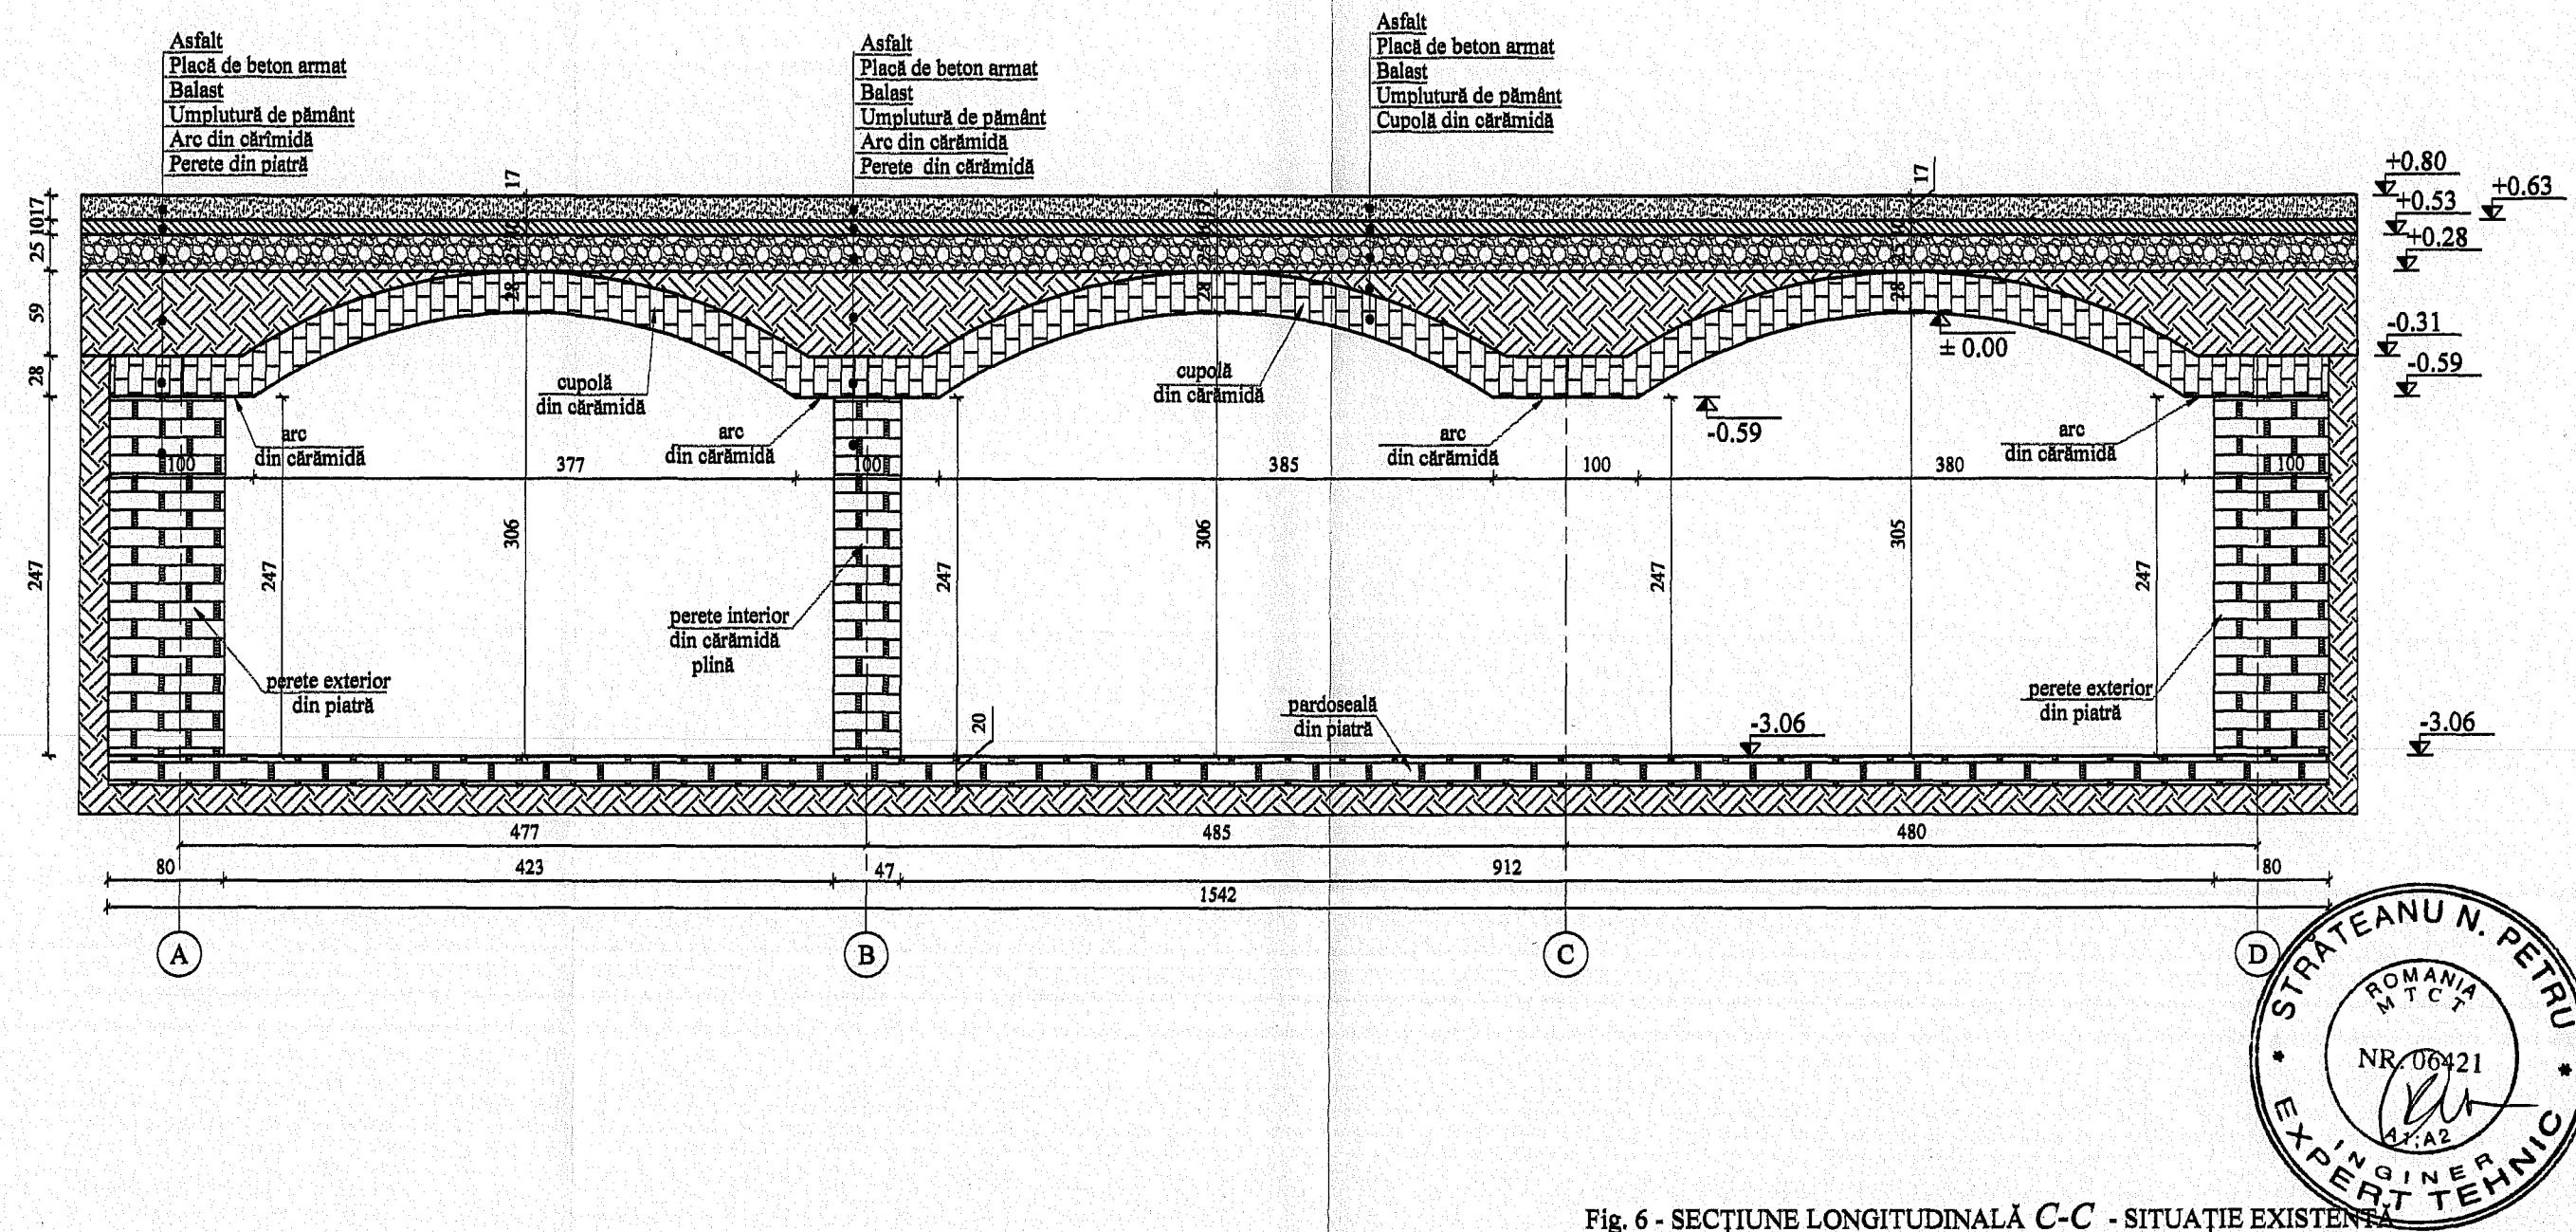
SECTIUNE LONGITUDINALĂ C-C - SITUAȚIE EXISTENTĂ
